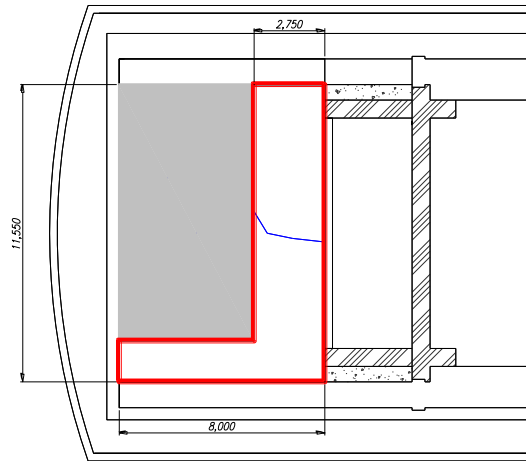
上部低拡散層の露出範囲（平面図） [1]
